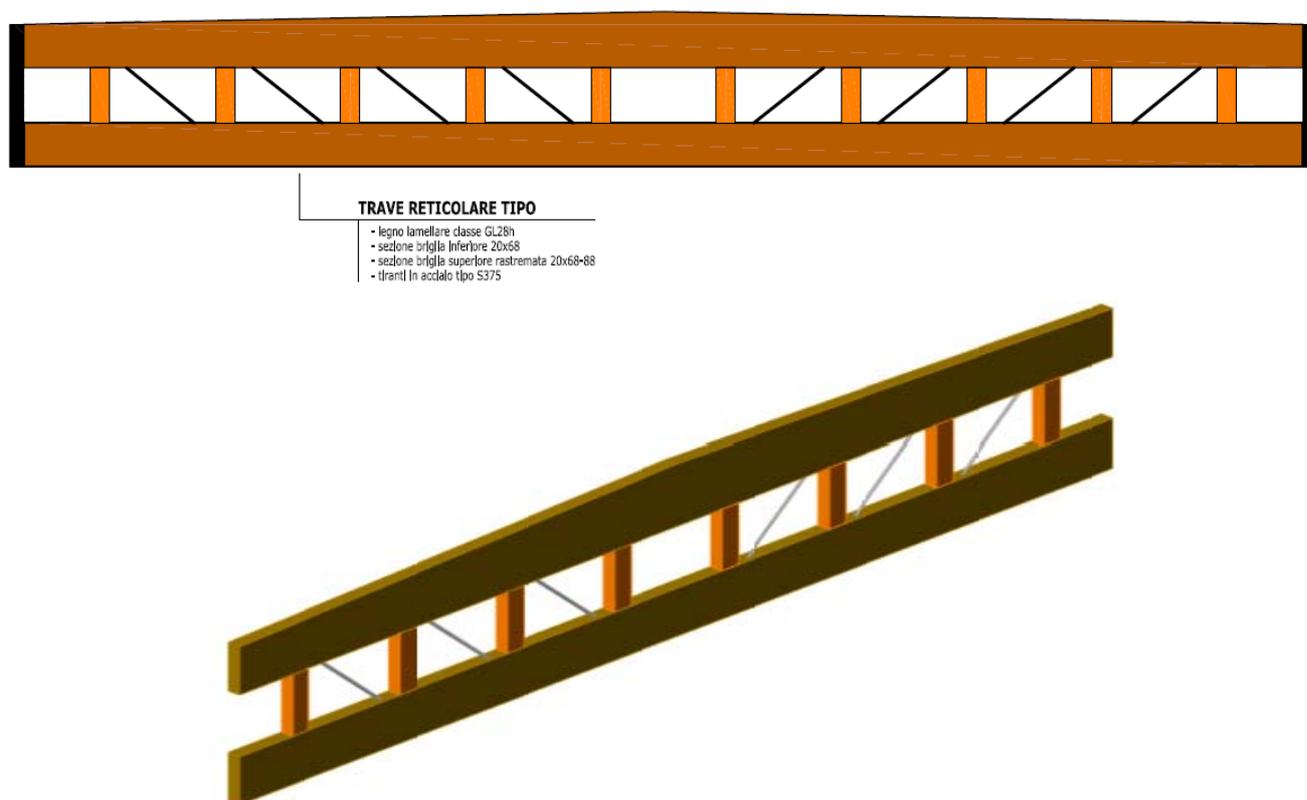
6: trave reticolare tipo - zona tunnel centrale
